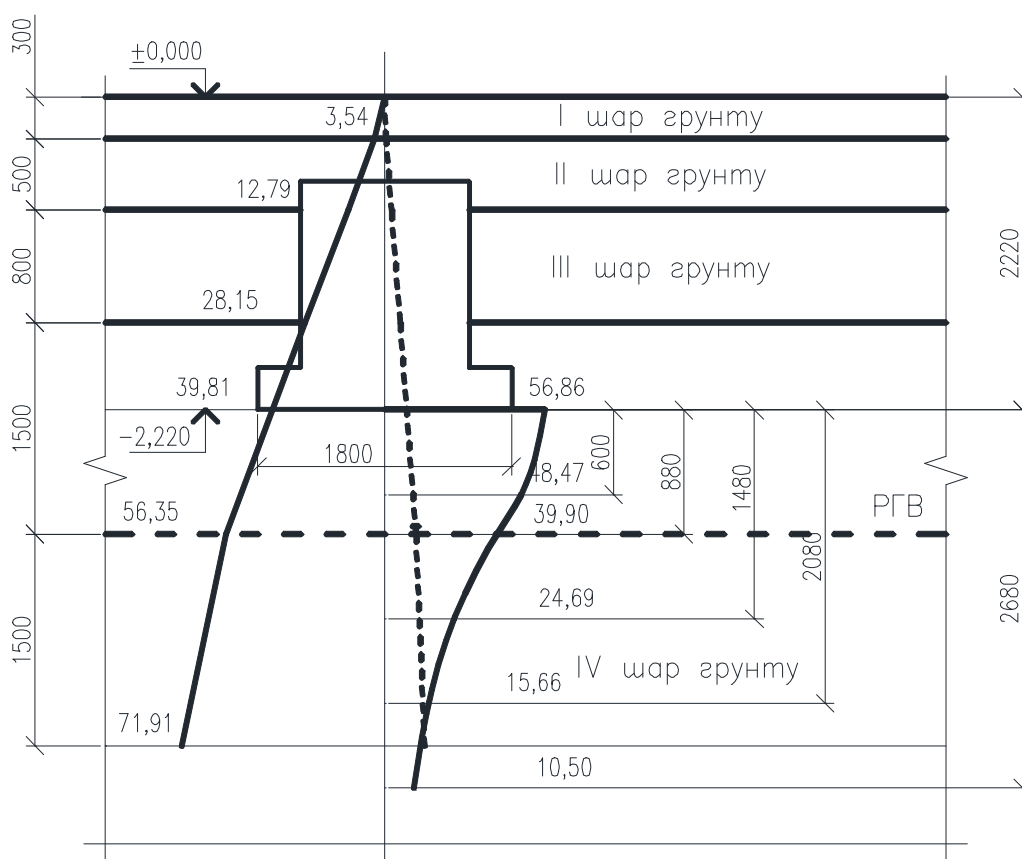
Ґрунтовий стан будівельного майданчика по ряду А
